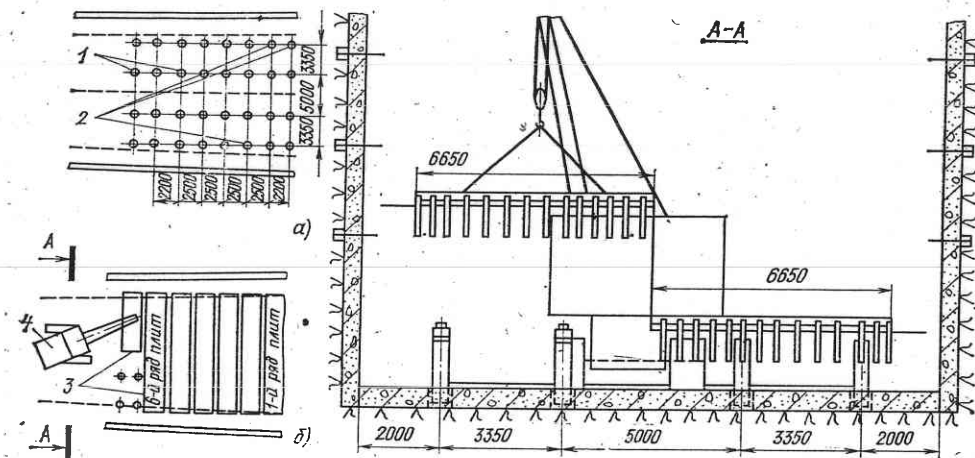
Монтаж облицовок пола строительного туннеля:
